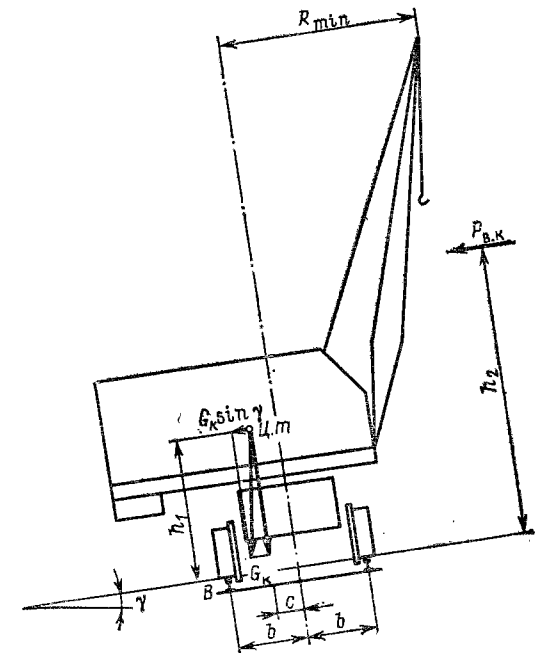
Расчетная схема собственной устойчивости поворотного крана:
